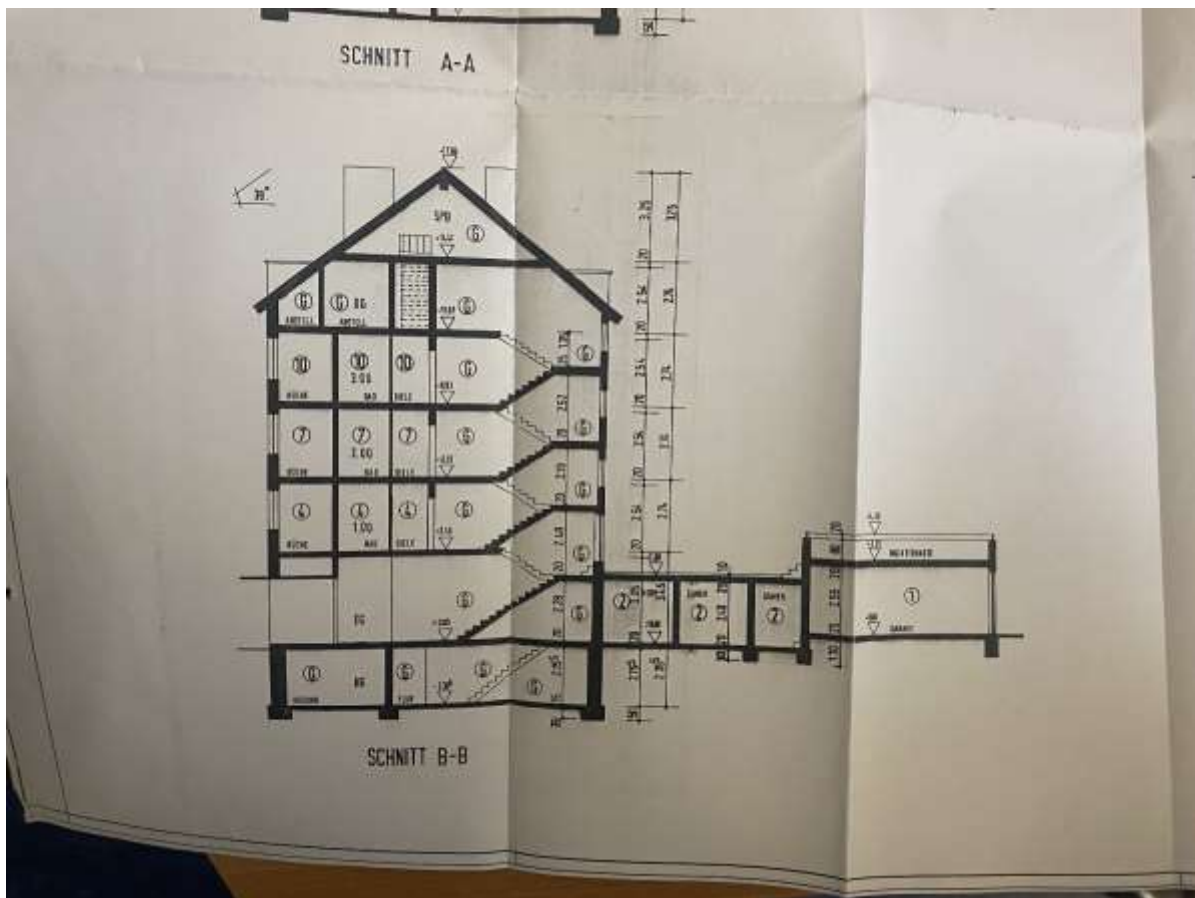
Schnitt / Quelle: Aufteilungsplan Grundakte
